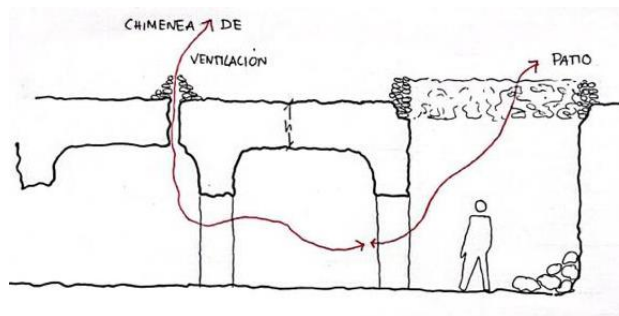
Ventilación en vivienda tipo bajo el plano del suelo a través de patios excavados en el plano y chimenea abierta en la cubierta vegetal. Boceto de elaboración propia.
